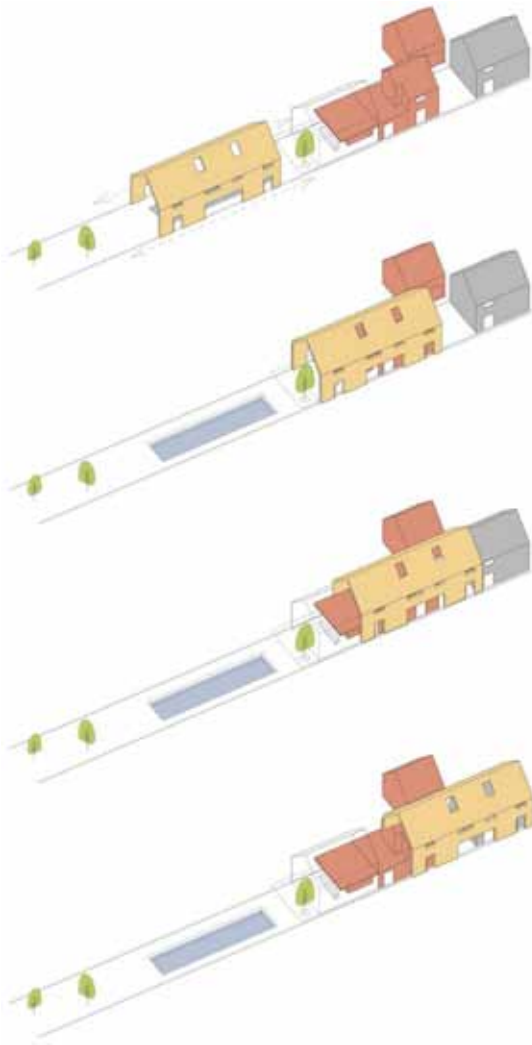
Sliding house, drmm, (fonte: <http://drmm.co.uk/projects/sliding-house/>)
